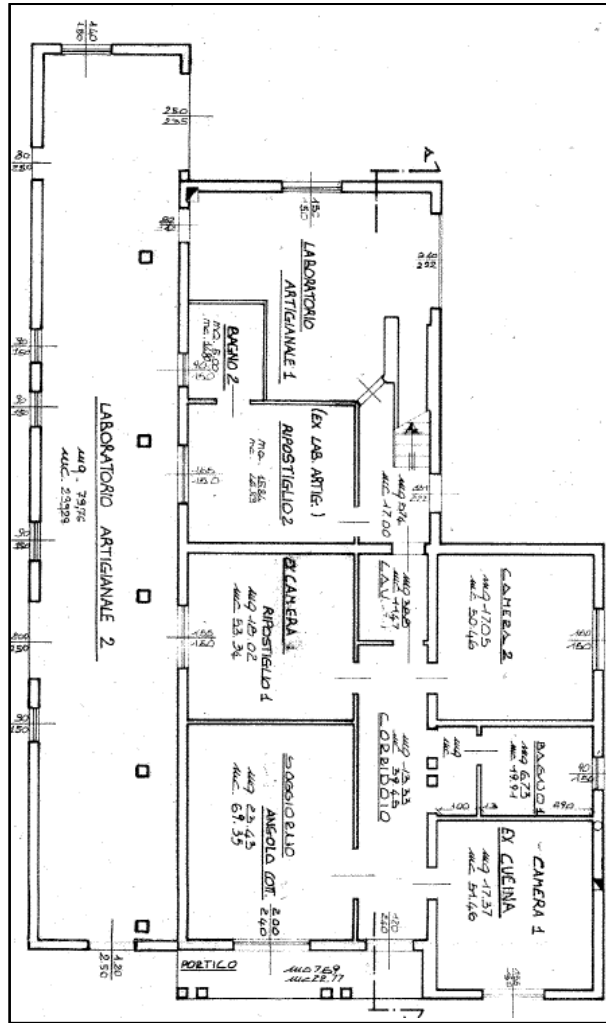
Concessione edilizia n. 1635 del 2001, pianta di progetto del piano terra
